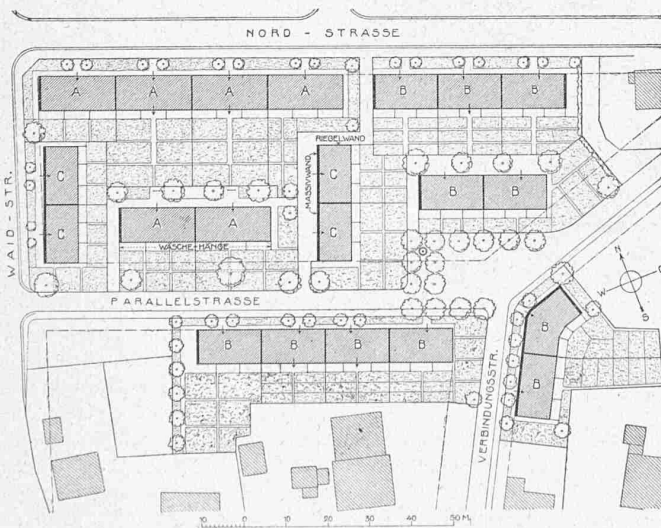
Lageplan der Gruppe von 21 Wohnhäusern zu je 6 Wohnungen.
